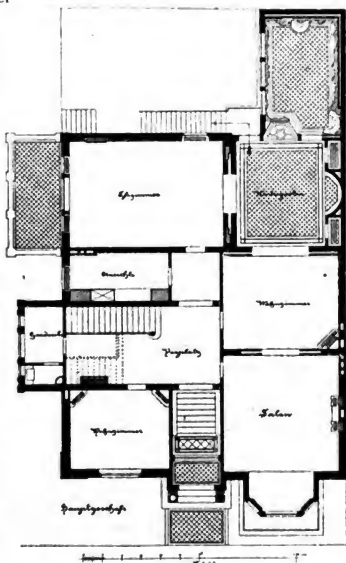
und 469. Wohnhaus Marwede, am Dobben. Fassade und Grundriß. Architekt K. Bollmann.
